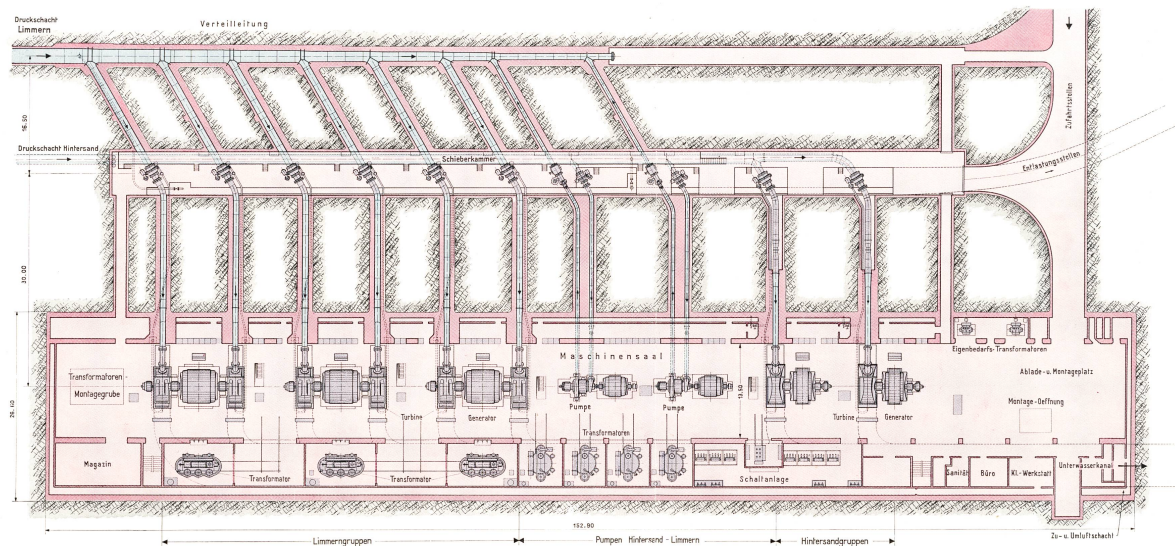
Grundriß der Kavernenzentrale Tierfeld
